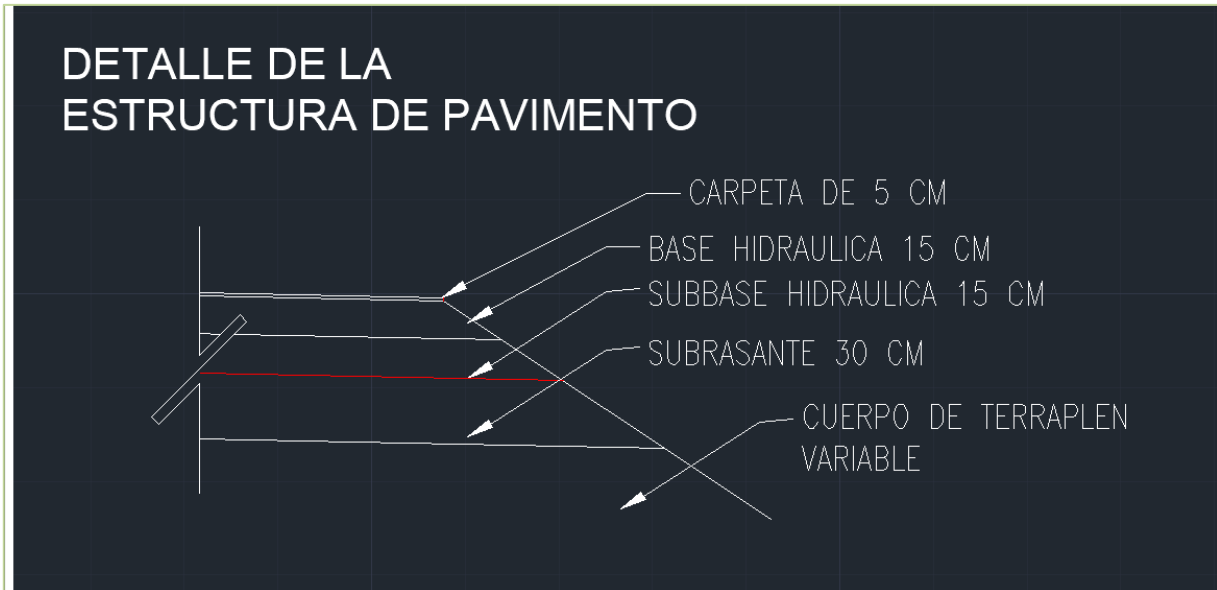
Secciones tipo y detalle de estructura sin escala
